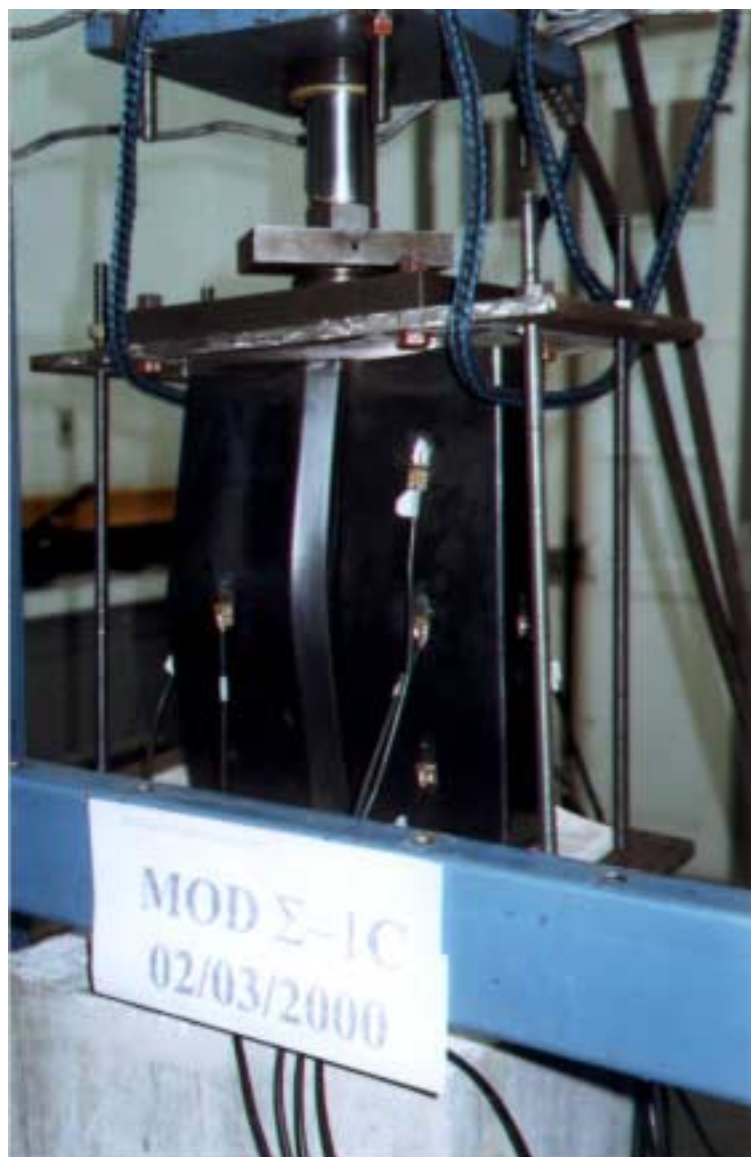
Mecanismo de colapso do perfil MOD  $\Sigma$ -1C.
